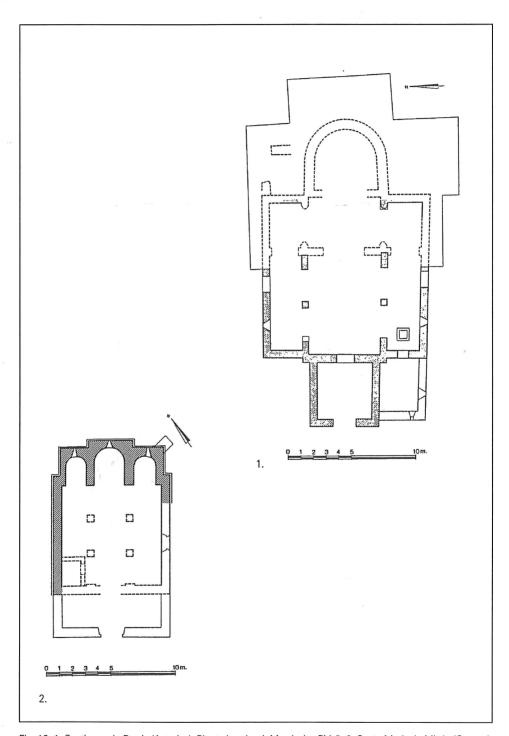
1. Santianes de Pravia (Asturias). Planta (según: J. Menéndez Pidal). 2. Santa María de Mixós (Orense). Planta (según: Lorenzo Fernández)
